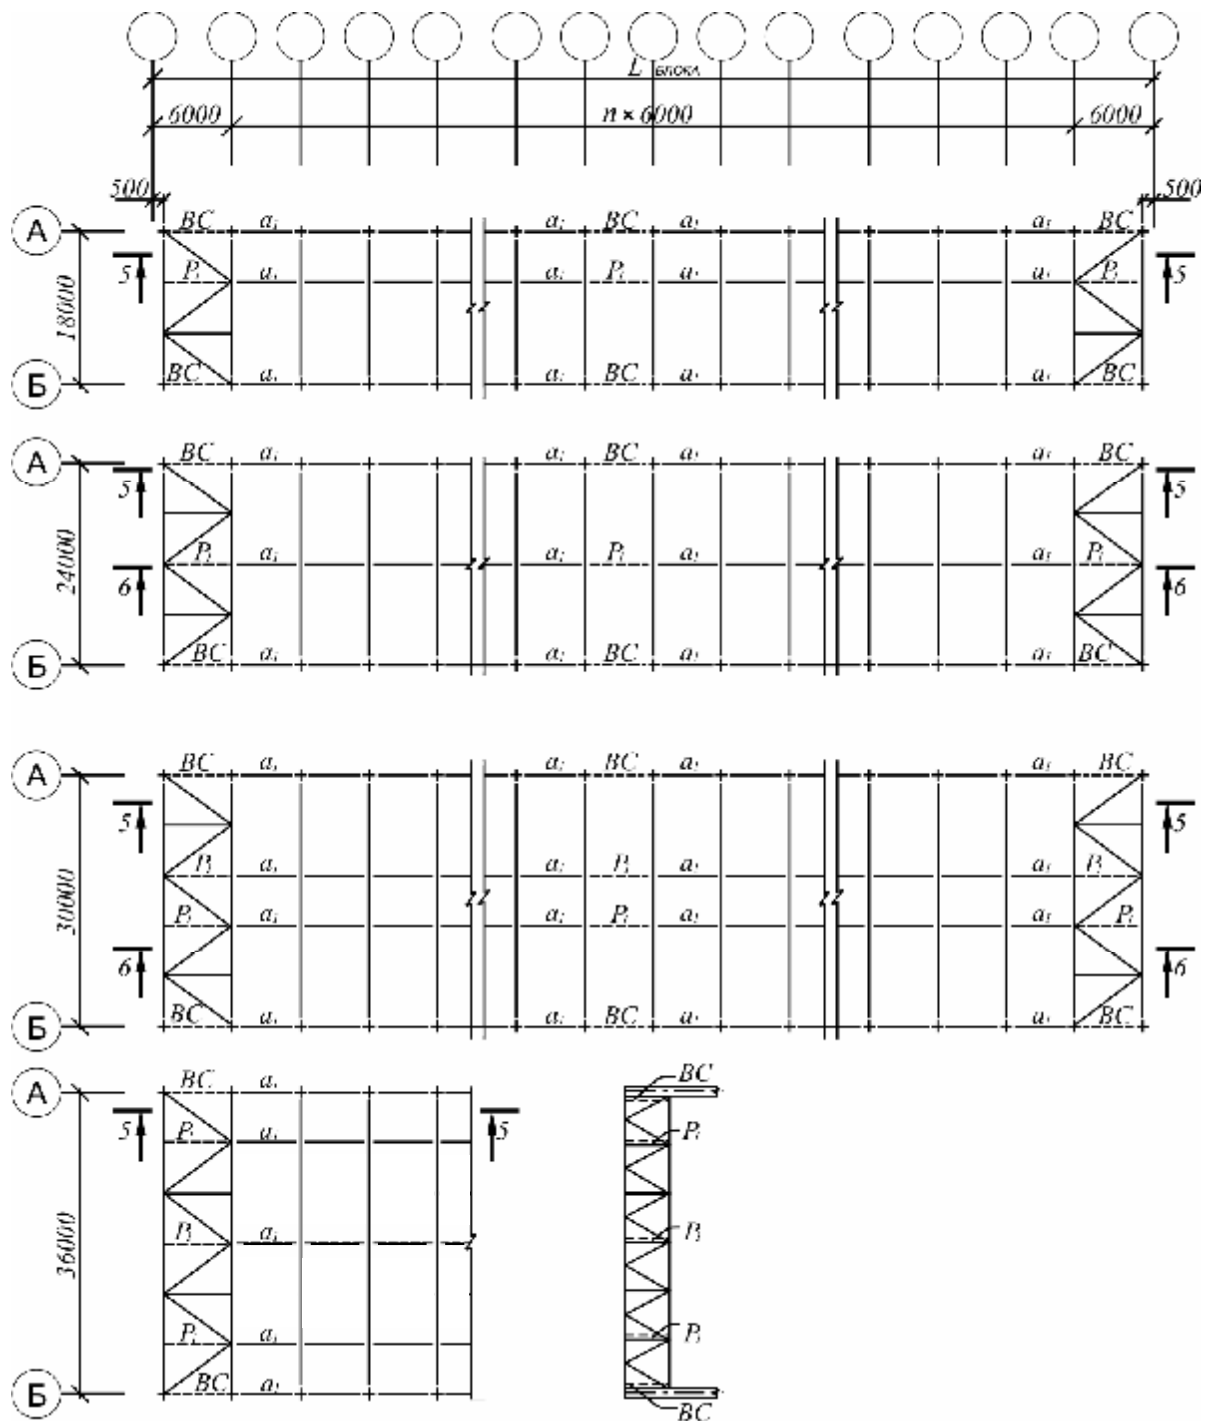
Безпрогонне покриття, крок ферм 6 м
